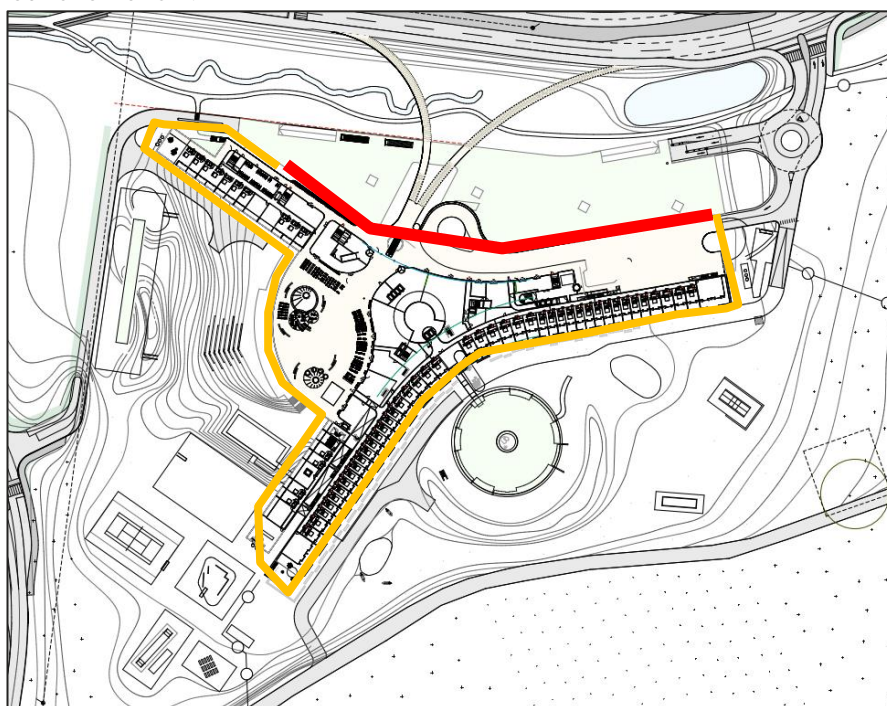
Plan d'implantation du projet (source : Felix Giorgetti)
